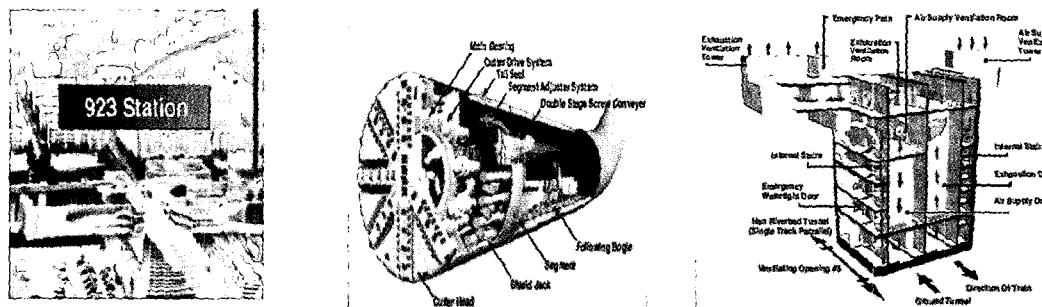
Shield Machine & 작업 및 유지관리용 수작개
